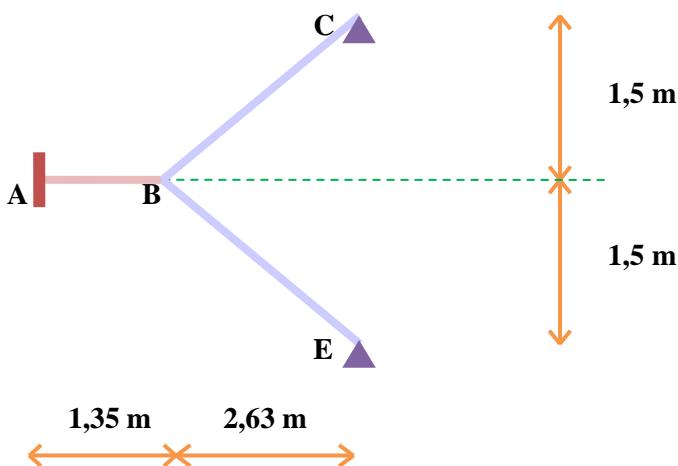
9 Sketsa Denah Lantai Lobby Area Tangga
